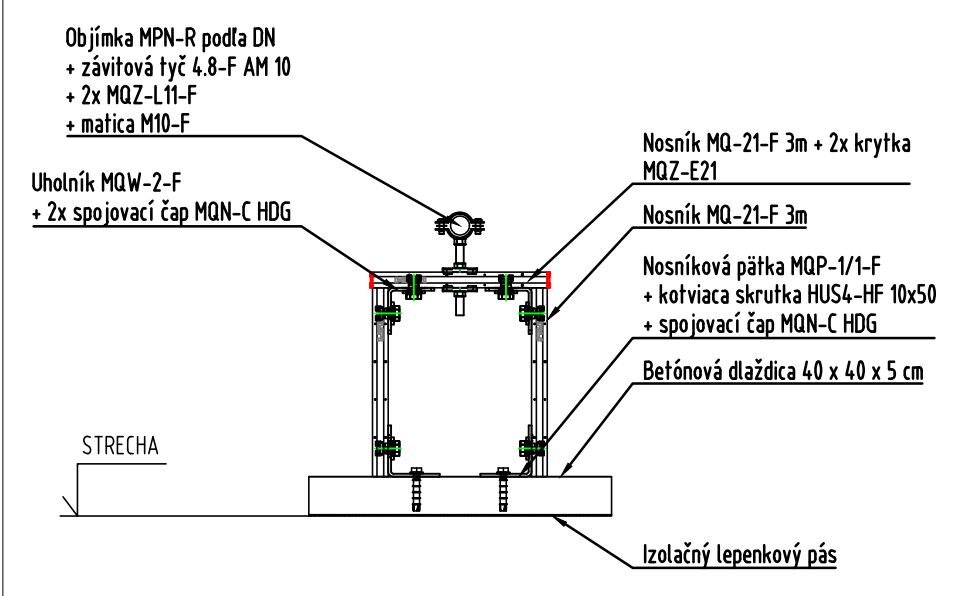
DETAIL PRESTUPU STREŠNÝM PLÁŠŤOM
